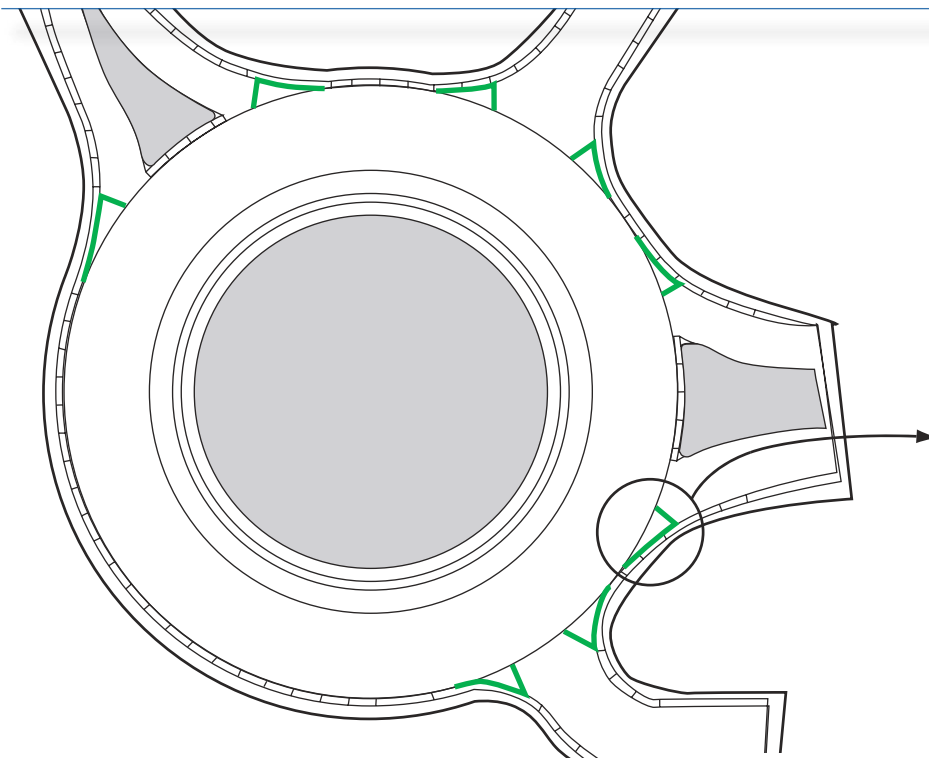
Pavimentazione CRCP all'innesto dei bracci di ingresso e uscita.
